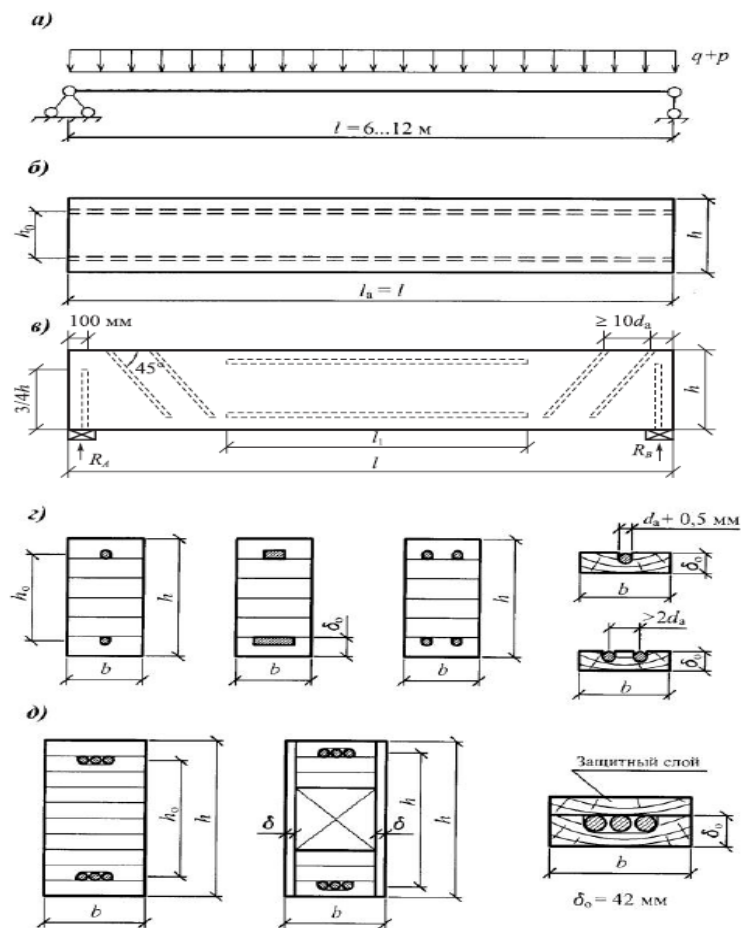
Армування балки з клеєної деревини: *а* – схема прикладання навантажень; *б* – схема армування балки одиночними стрижнями; *в* – схема армування балки; *г* – типи поперечних перерізів з одиночним армуванням; *д* – типи поперечних перерізів з груповим армуванням.
